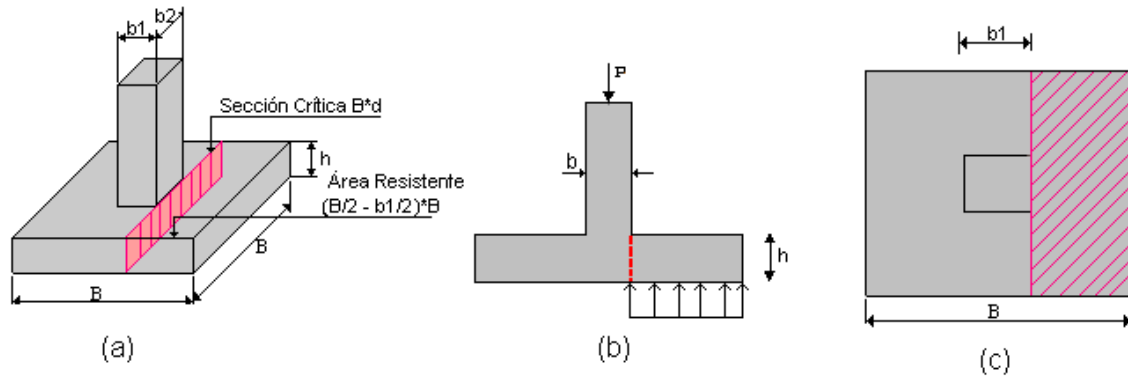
Sección Crítica para el Cálculo del Momento en Zapata que Soporta Columna, Pedestal o Muro de Concreto.
